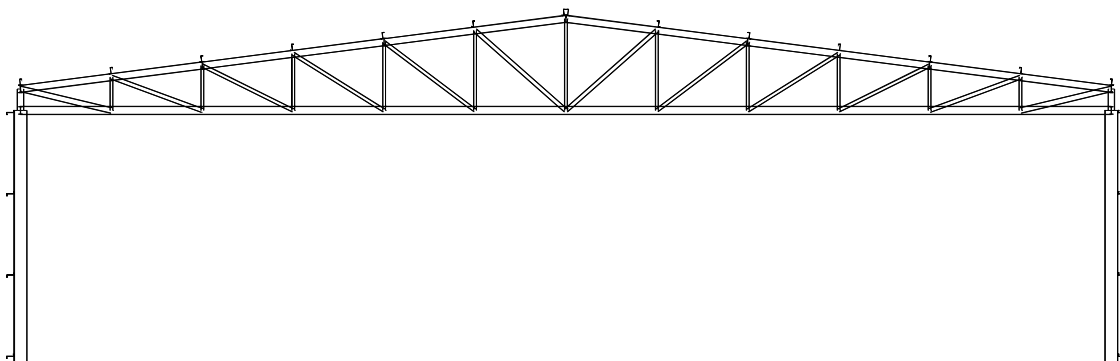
Pórtico de pavilhão industrial, pilar em perfil de alma cheia, viga em treliça
